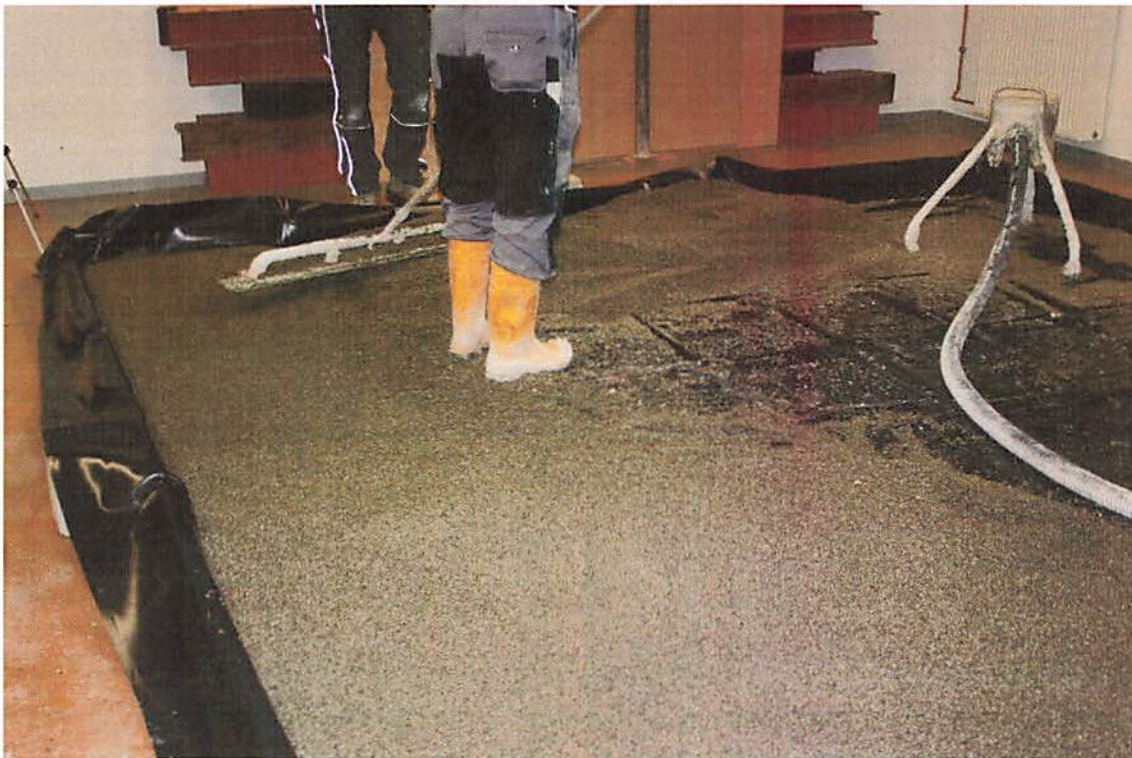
Versuchsflächen mit Teichfolie vor Einbau der Leichtausgleichestriche
